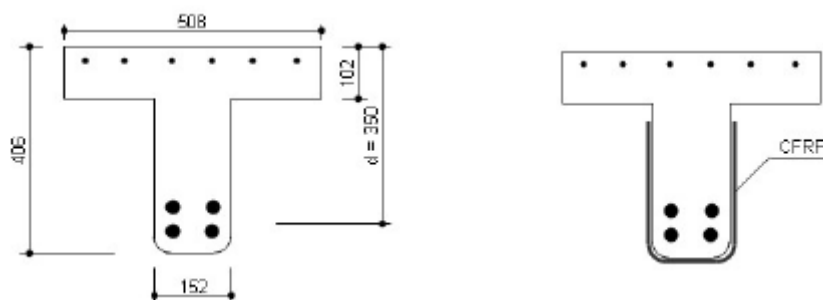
Geometria das vigas ensaiadas por Chaallal *et al.* (2009) (dimensões em mm).
